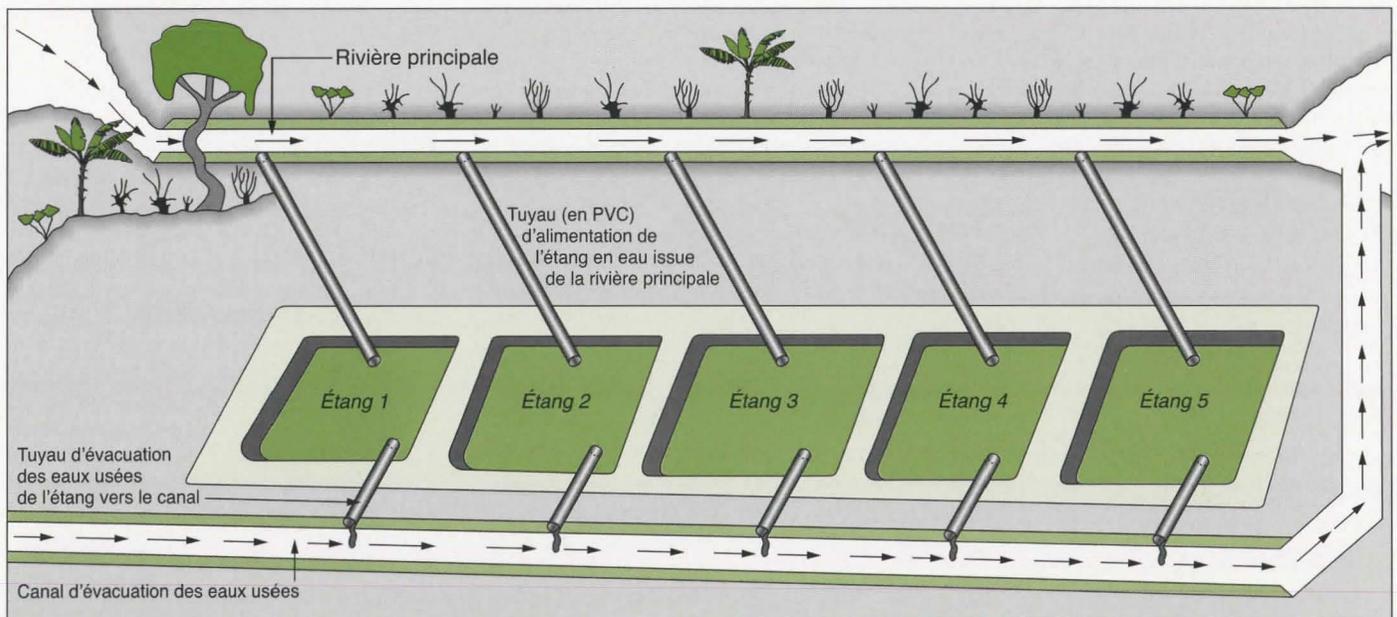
Plan général et disposition des étangs dans le site d'essai.
